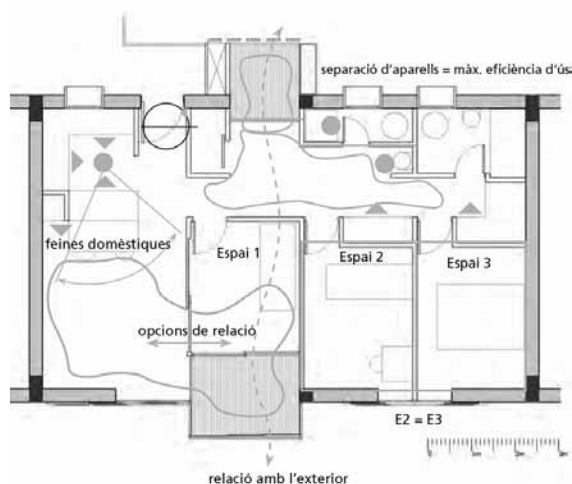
Aplicación de los 14 + 1 puntos en un proyecto básico de viviendas, Montaner Muxí Arquitectes.
